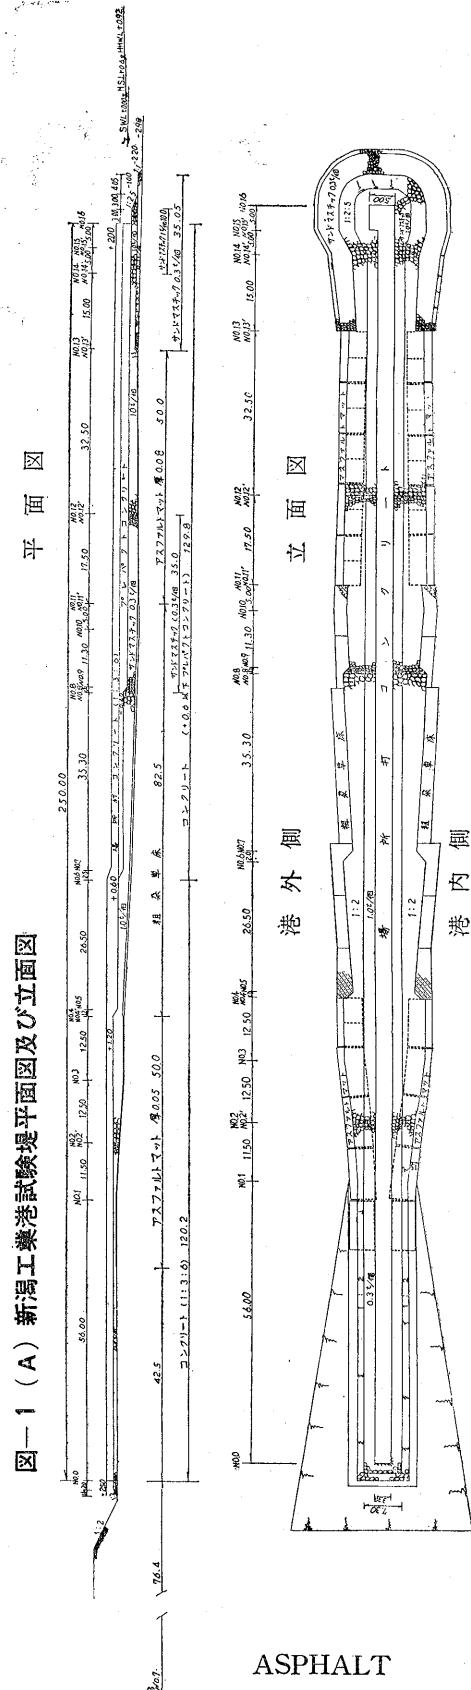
(A) 新潟工業港試験突堤平面図及び立面図
